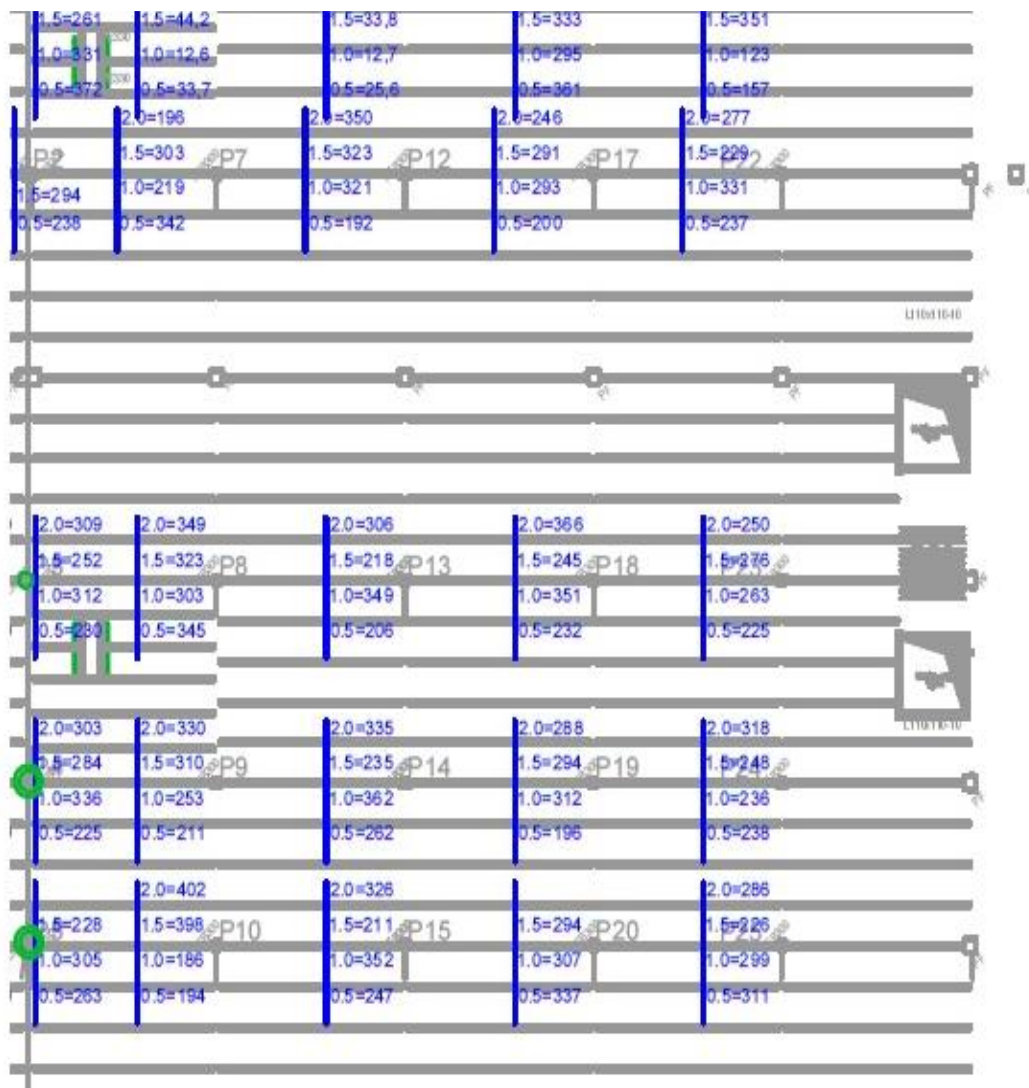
Localização do ensaio de medição da espessura da tinta corta-fogo nos pilares metálicos com um medidor de espessuras de camadas no módulo B5 do piso 1
